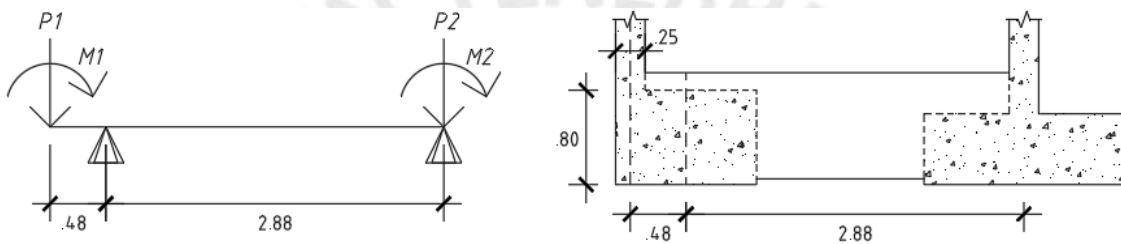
Modelo de cálculo de la viga de cimentación del eje 8.
